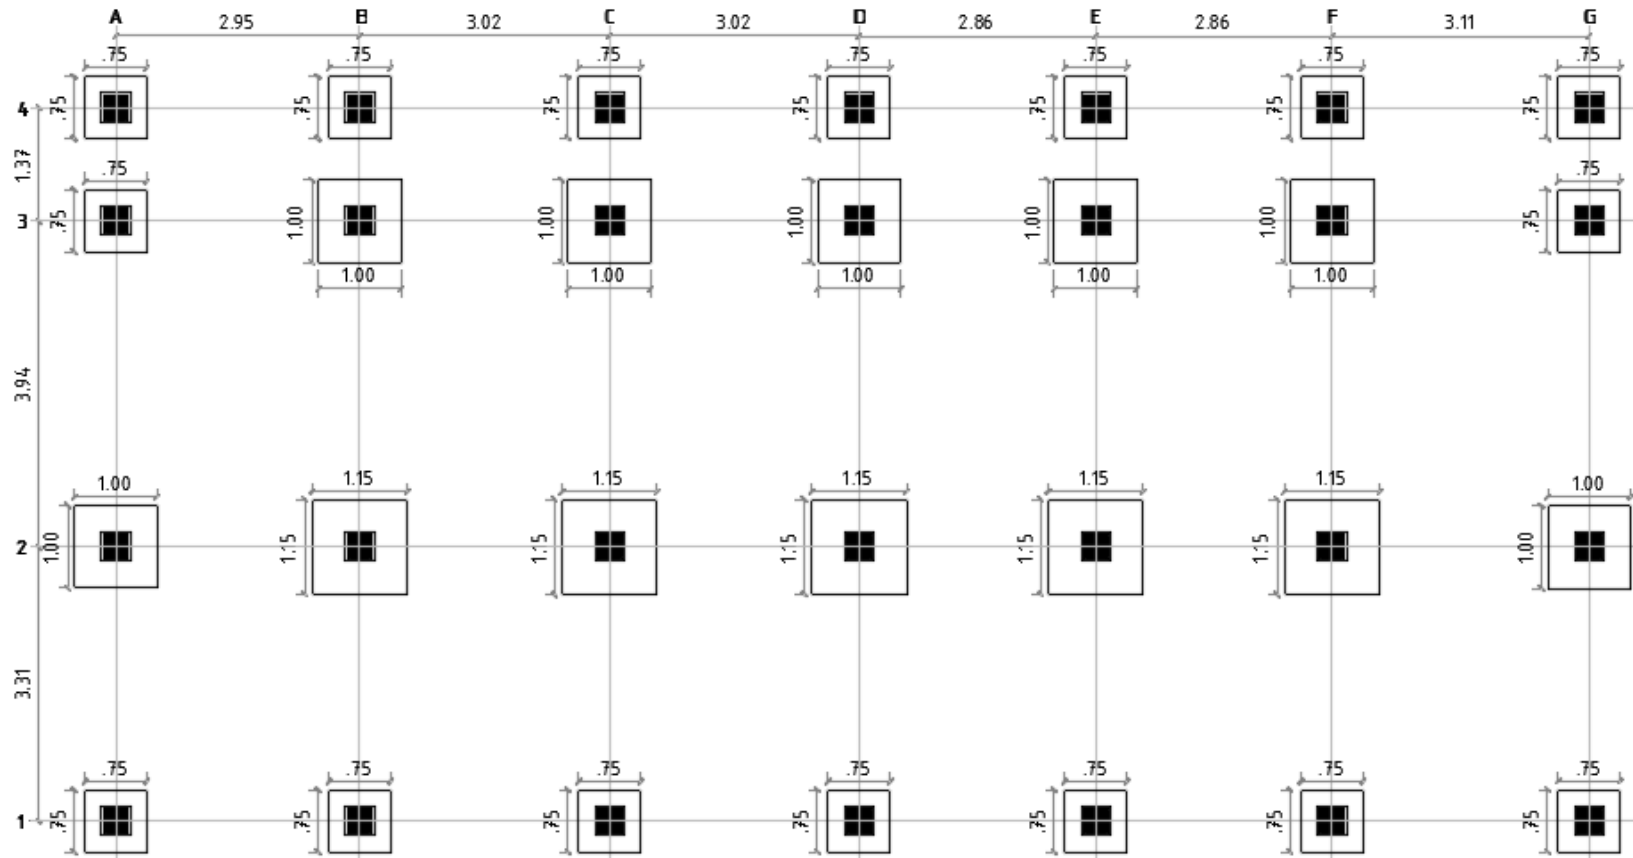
Configuración en planta con la ubicación de las zapatas aisladas
